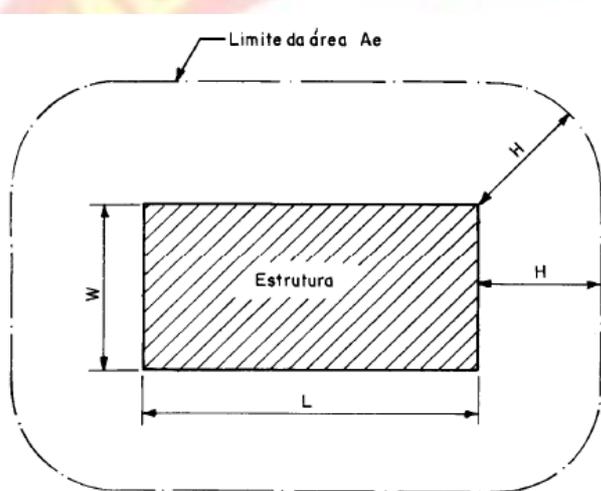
Delimitação da área de exposição equivalente ( $A_e$ ) - Estrutura vista de planta
